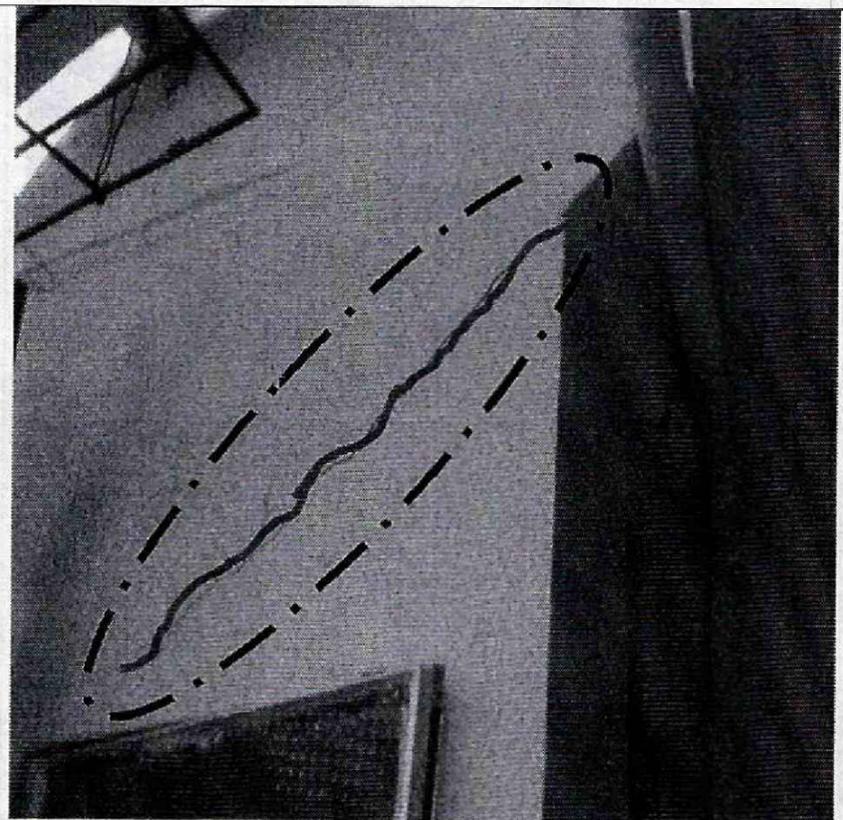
Fisuras identificadas en muros de cerramiento y divisorios en la vivienda de la Carrera 98 B No 136 - 64
